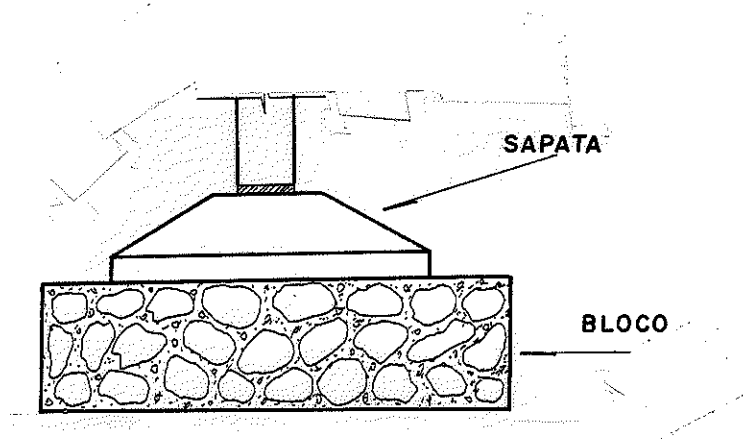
Fundação em Sapata e Bloco
